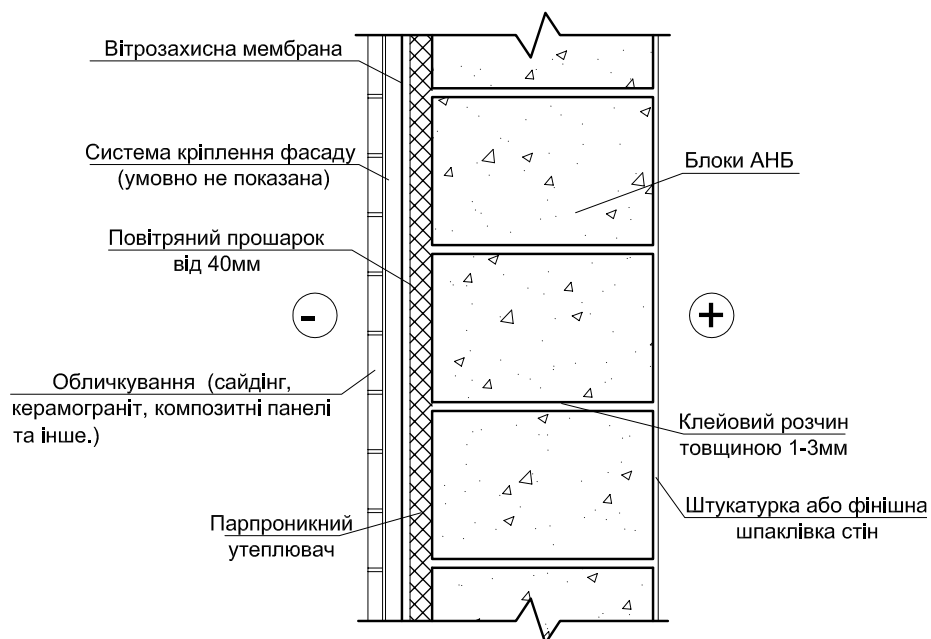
7-6. Багатошарова стіна з опорядженням фасадною системою з утеплювачем, повітряним прошарком і навісним облицюванням
